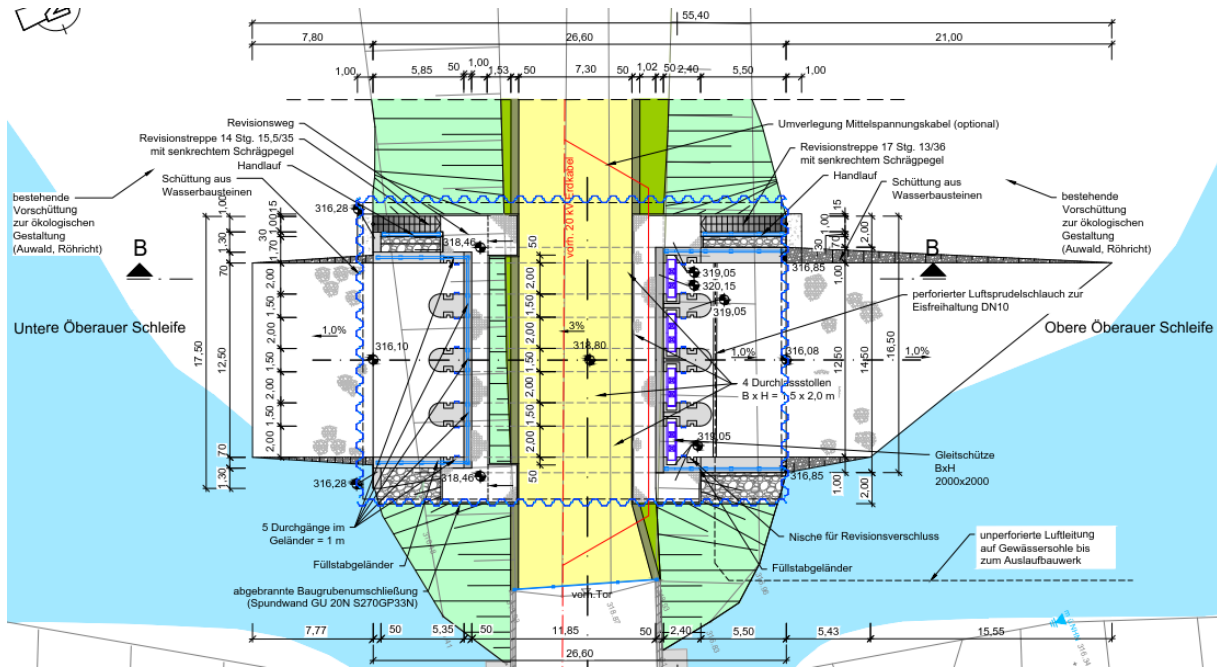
Verbindungsbauwerk, Draufsicht (aus Plan 04-03-05)
